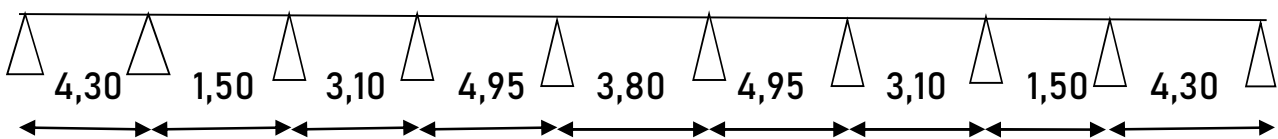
Schéma statique de la poutrelle Utilisée.
